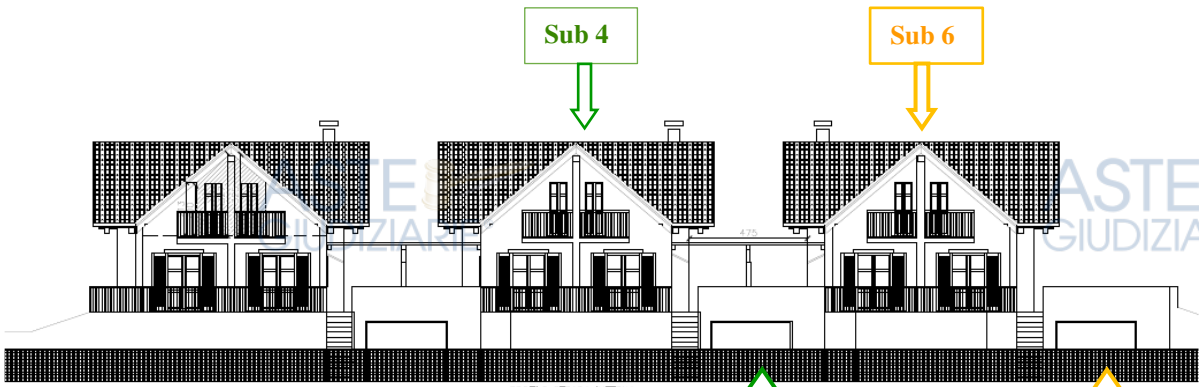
I due villini sub 4 e sub 6, con le relative autorimesse sub 5 e sub 6, visti da sud ovest (estratto dalle tavole progettuali dell'arch. *)
